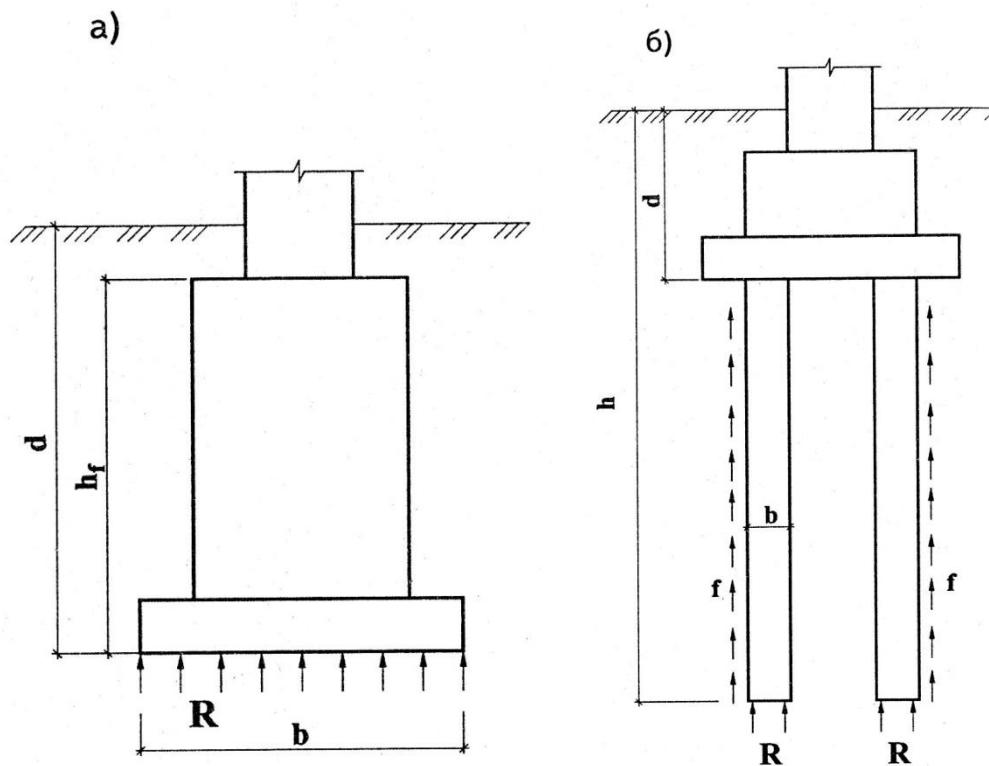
Схемы фундаментов: а) мелкого заложения;
